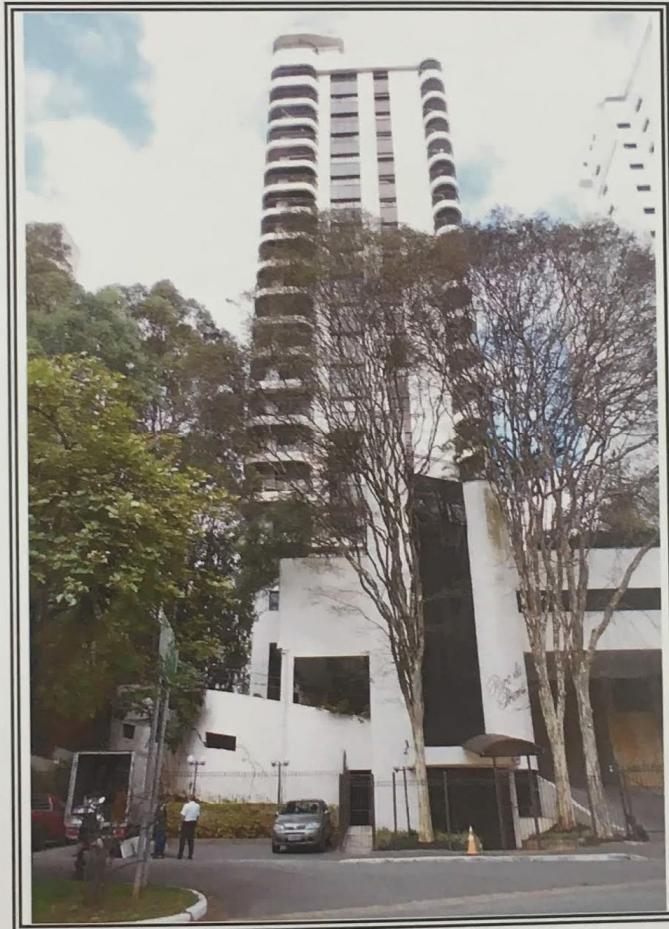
Vista geral da fachada do Condomínio Edifício Parc Des Princes
